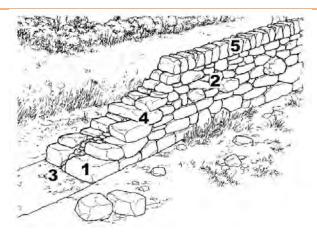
Etape de construction d'un muret en pierres sèches (source : https://lamaisonnature.ch/le-jardin-naturel/mur-de-pierre/)
